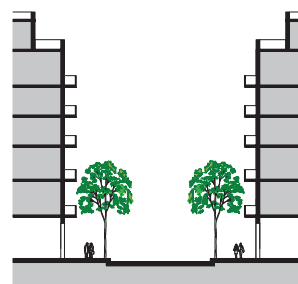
Sección transversal del Eixample, tipo: 20m.
